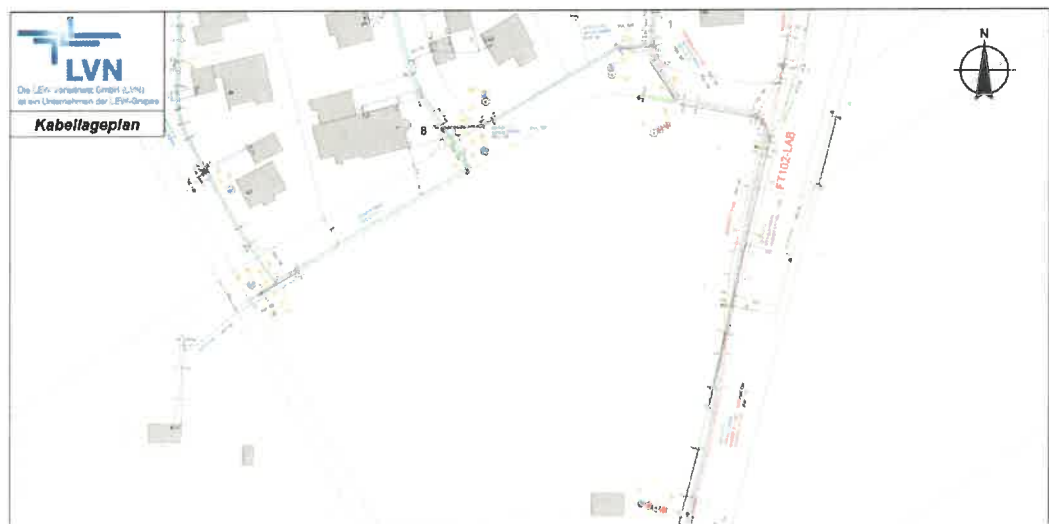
Kabellegeplan, ohne Maßstab, Quelle: LEW, Stand 17.04.24
